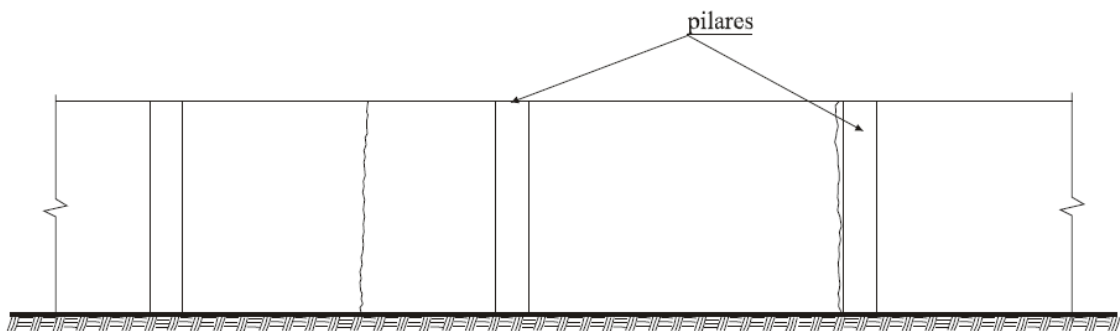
fissuras verticais em alvenaria devido à dilatação térmica
